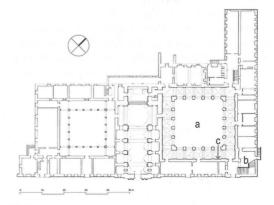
Planta del Colegio del Cardenal. a) Claustro principal; b) situación de la montea del pavimento; c) situación de la montea de la pared (levantamiento de Meijide 1984)
